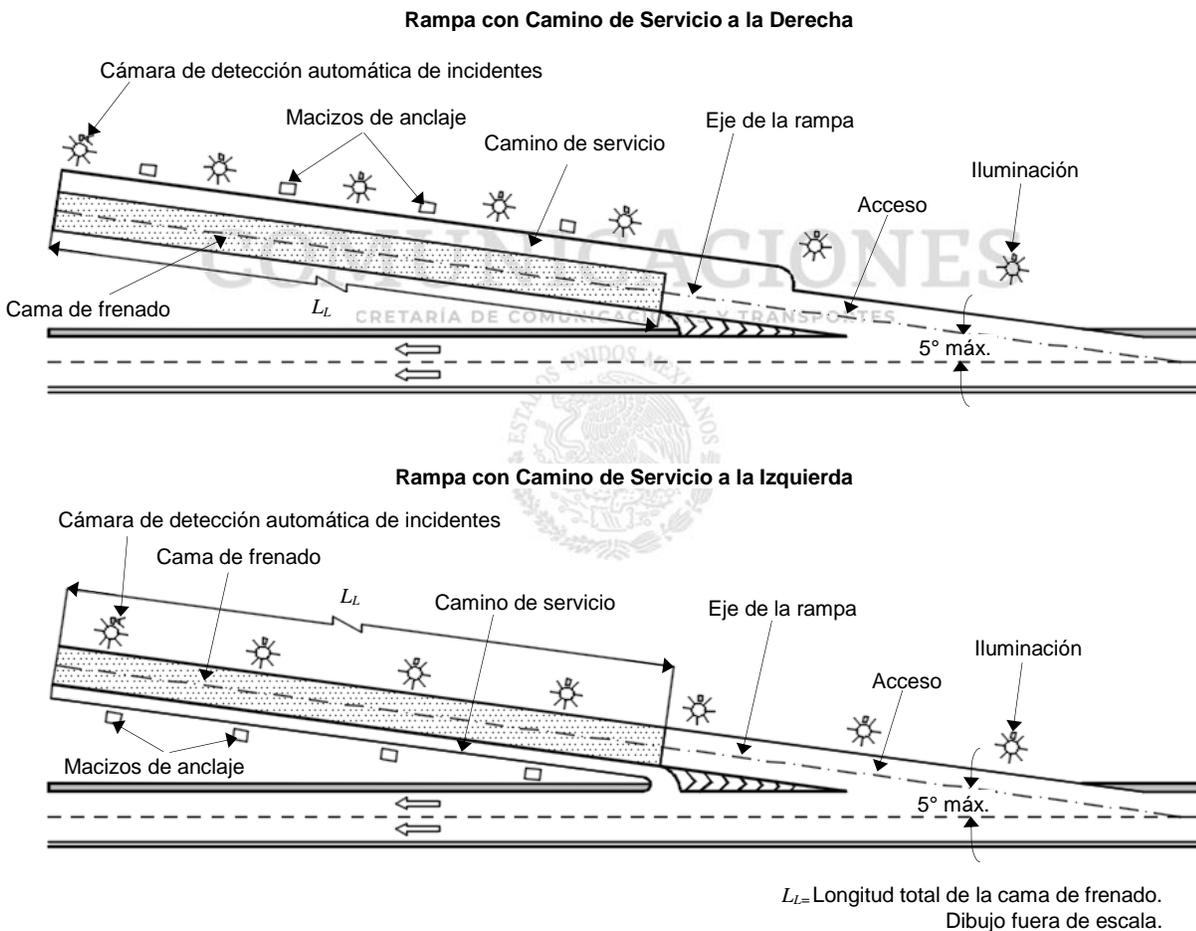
Disposición en planta de la rampa de emergencia para frenado
